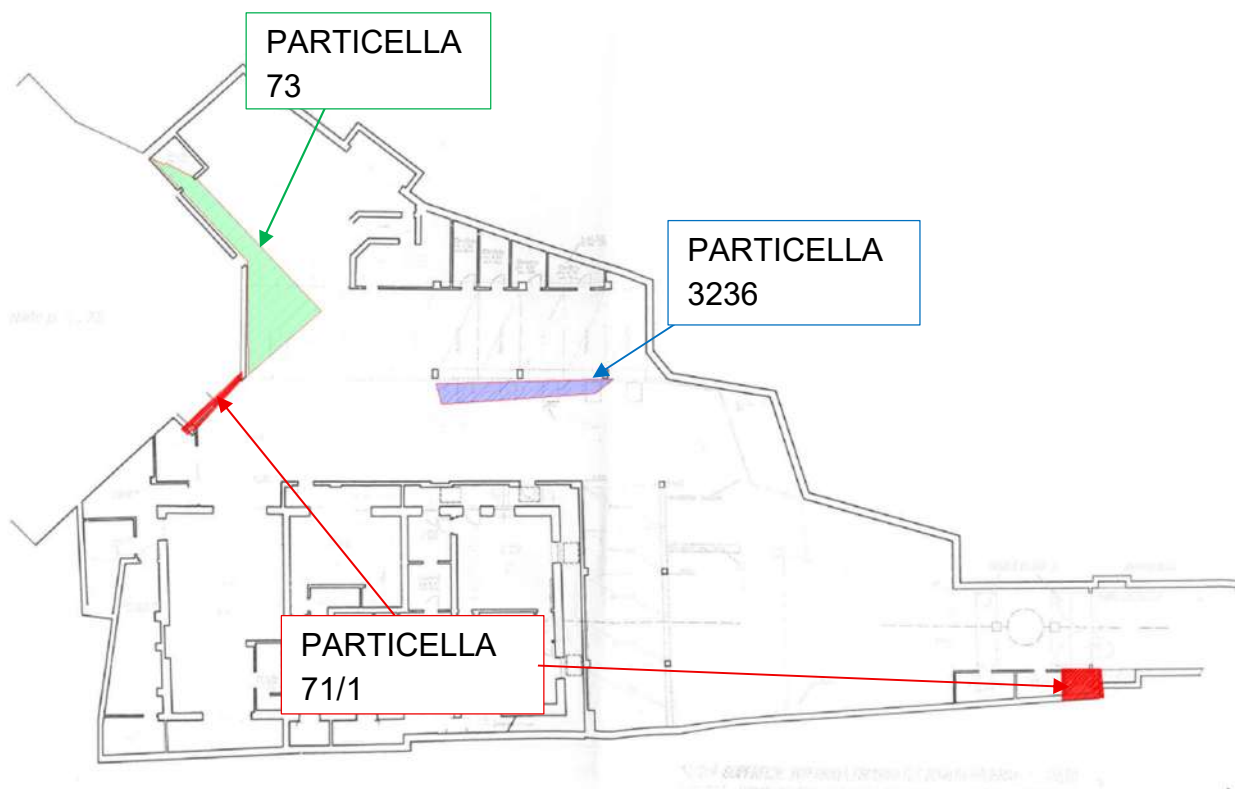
Stralcio planimetrico piano interrato con evidenziate le porzioni di interesse
